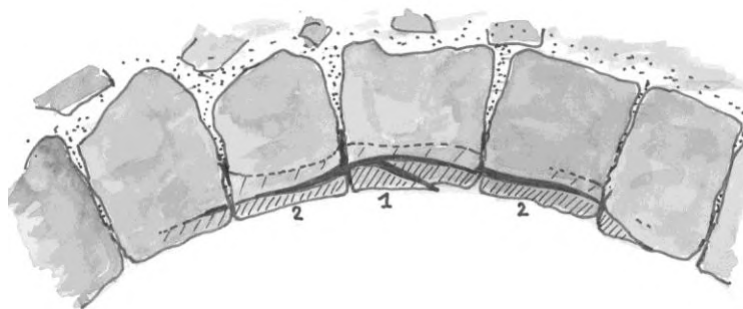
diagramma di distacco di pietra sulla calotta (notare l'assenza di malta tra le pietre che quindi si toccano; la caduta di una lastra dalla pietra 1 destabilizza le lastre delle pietre 2 che erano precedentemente tenute in posizione (la pietra 1 svolgeva il ruolo di chiave); se la pietra dopo il distacco suona ancora cava, questo significa che si stanno formando nuove superfici di distacco, mostrate dalle linee tratteggiate).
